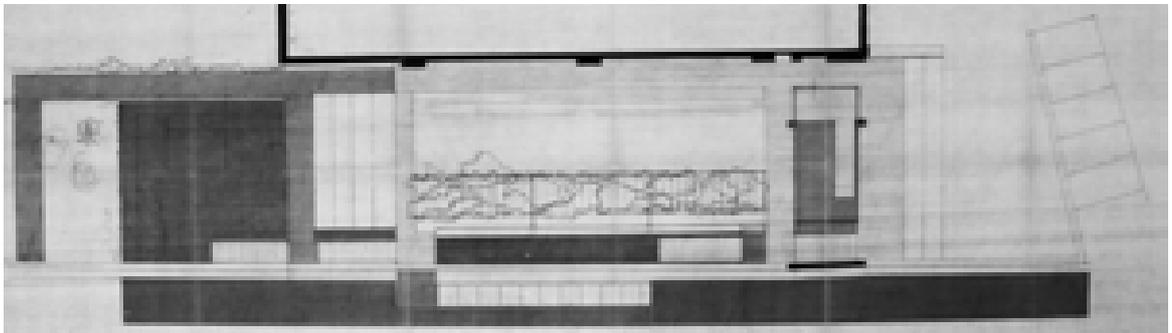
Pianta +5,30 – stato futuro - s.d. (AABS-95.470)
